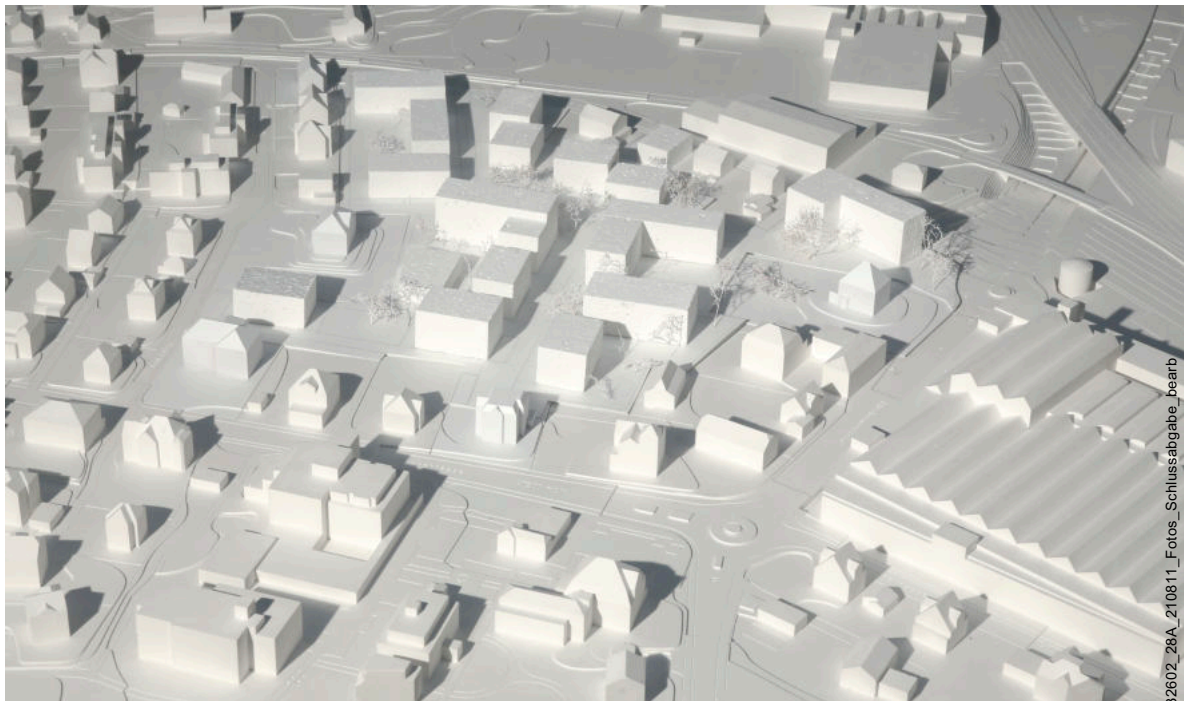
Modellfoto Ost-Ansicht, Team camponovo baumgartner architekten
